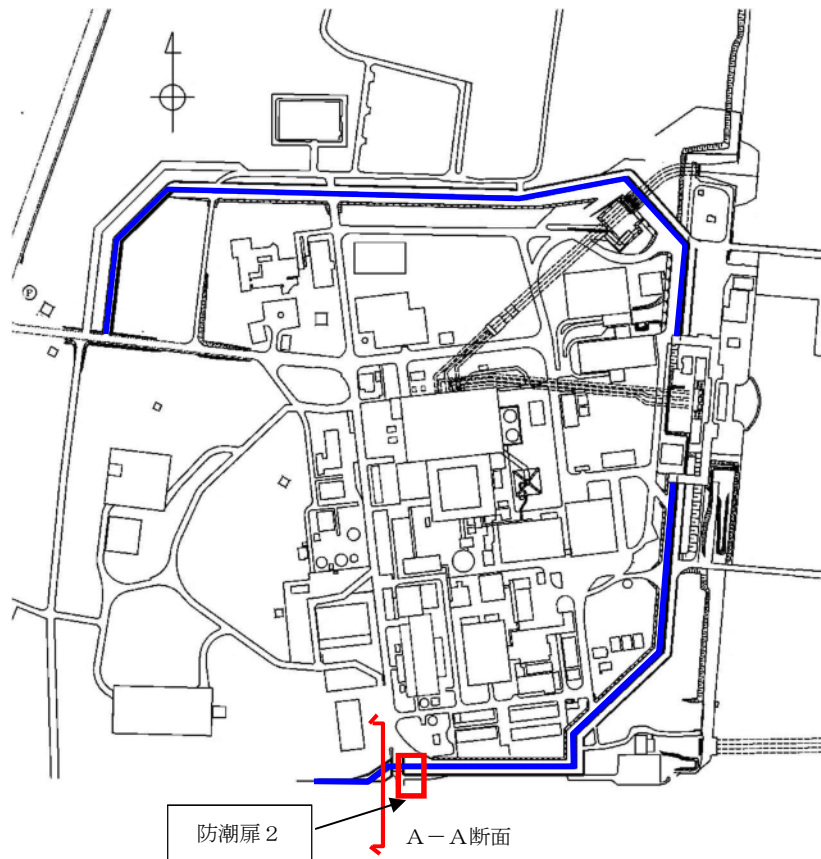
防潮扉 2 基礎 評価対象断面位置図
